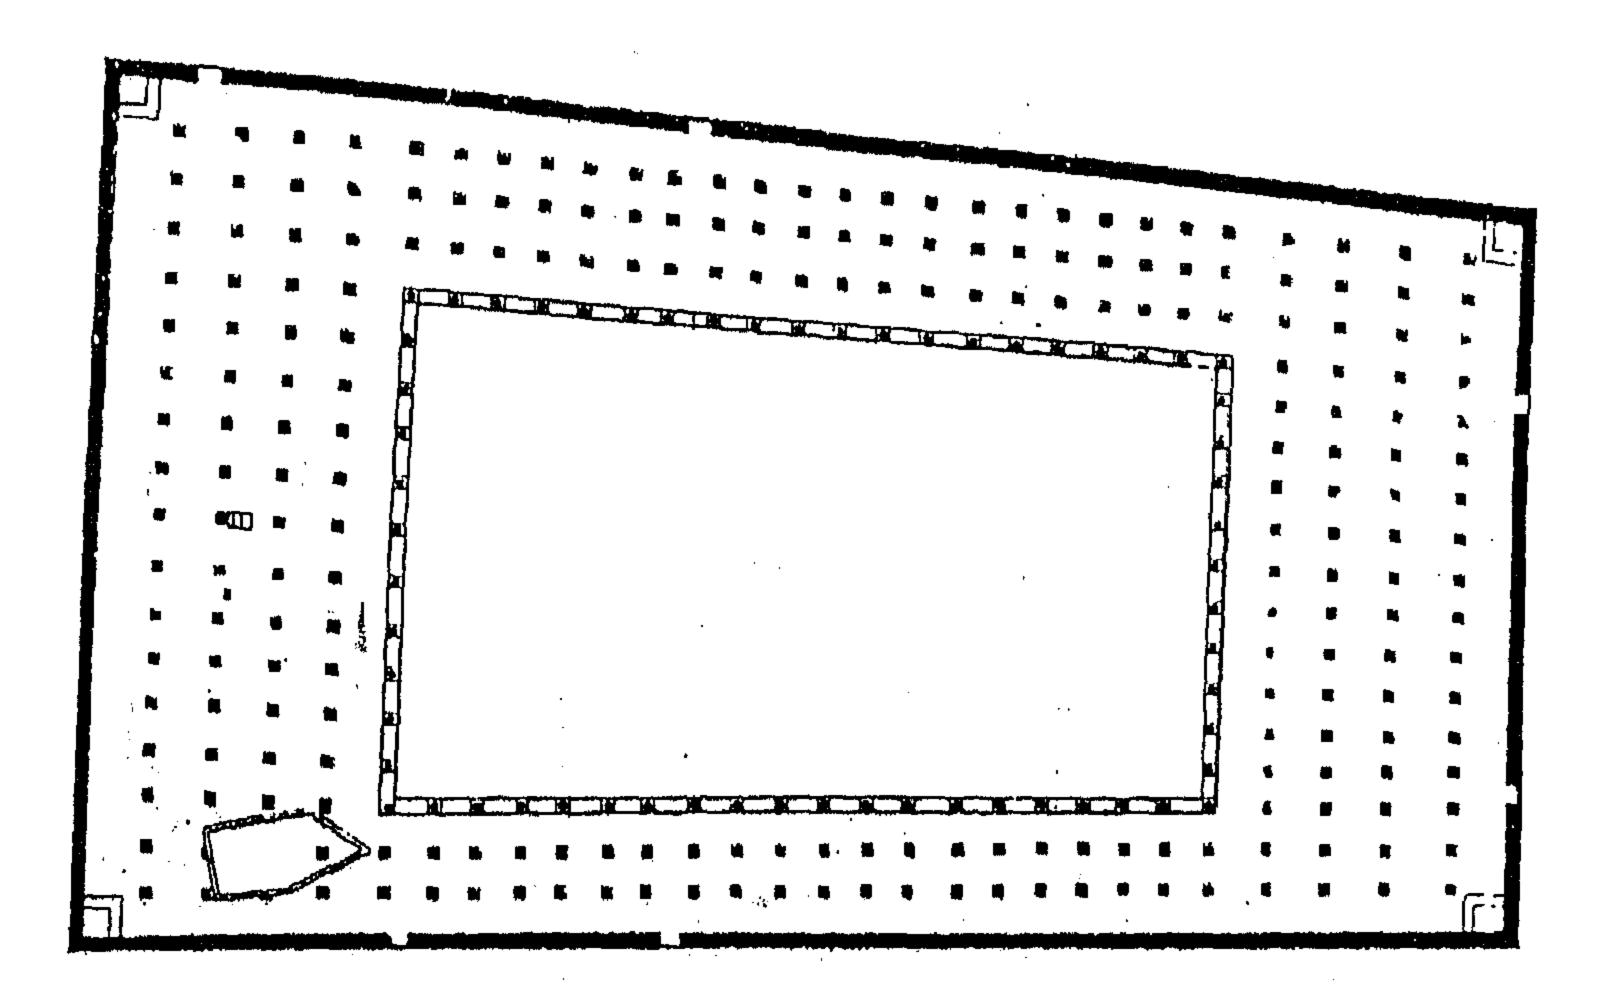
مسقط أفقي لمسجد الصالح طلائع في القاهرة (٥٥هـ/١٦٠م) . (عن : Brandenburg) .
